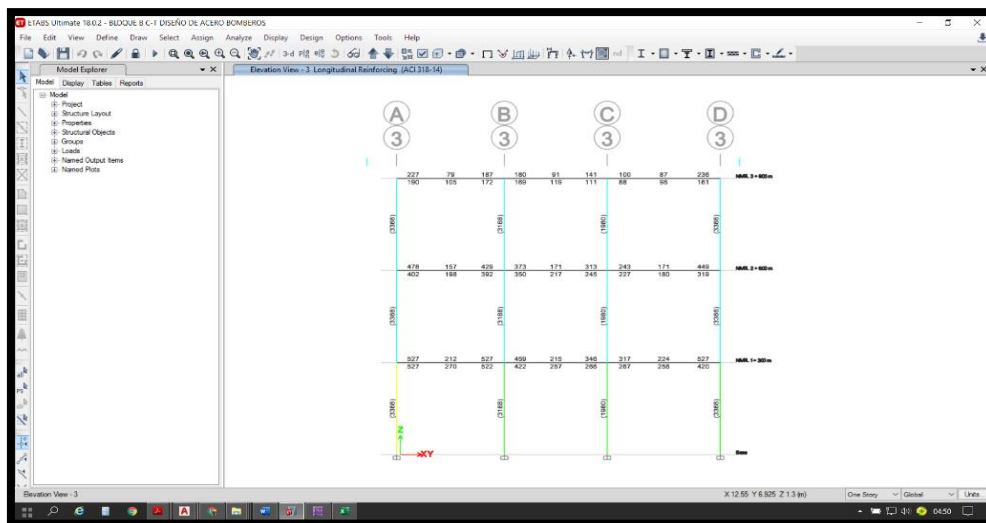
Bloque A - longitudinal en el eje elevación eje 3-3
